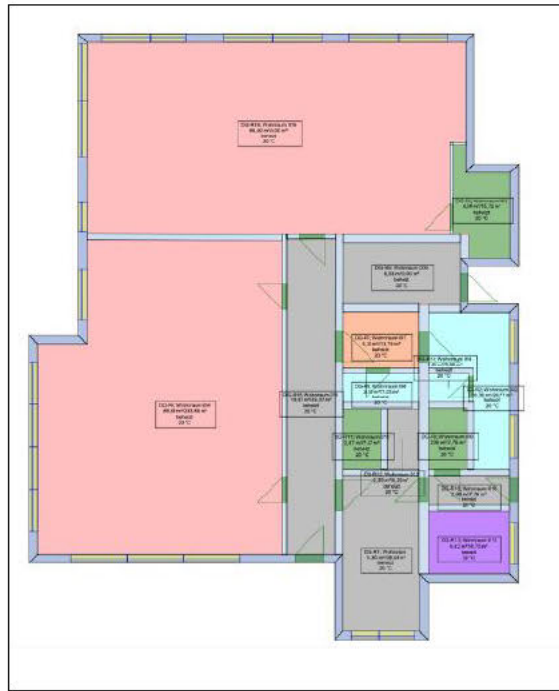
Erdgeschoss nach Zonen unsaniert
